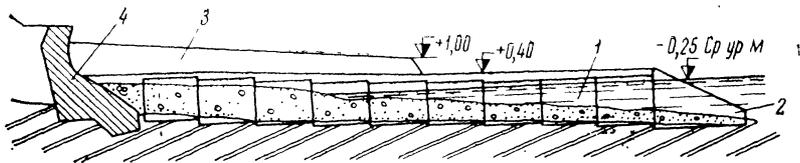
Бун из массивов (блоков) с монолитной бетонной надстройкой:
